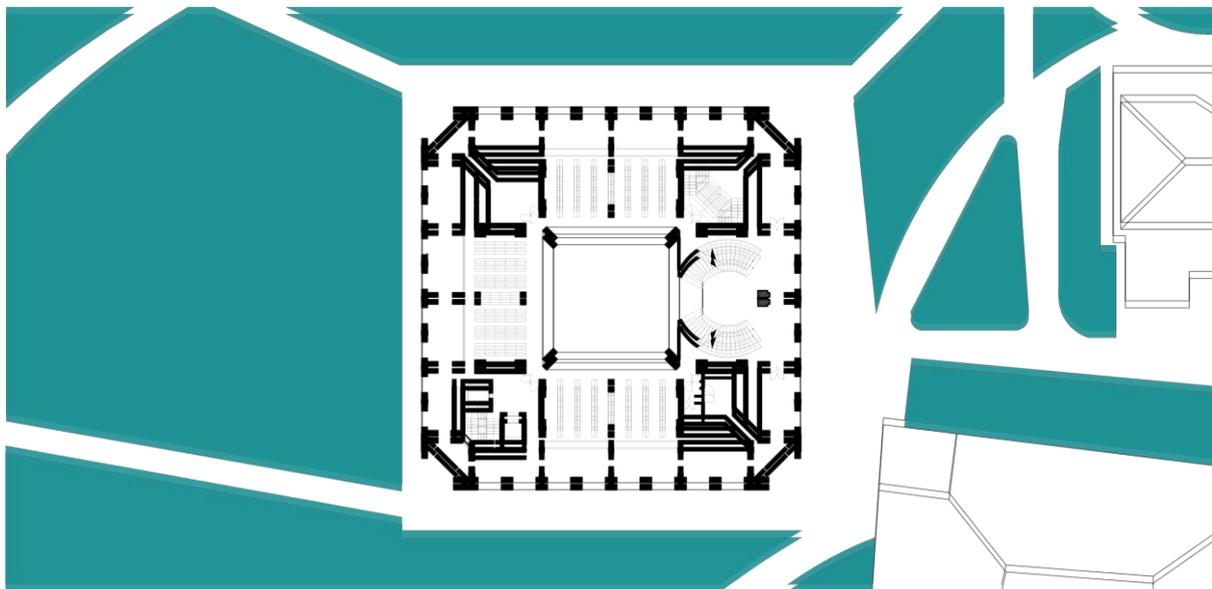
Análisis de precedente. Planta baja. Elaboracion Propia.
